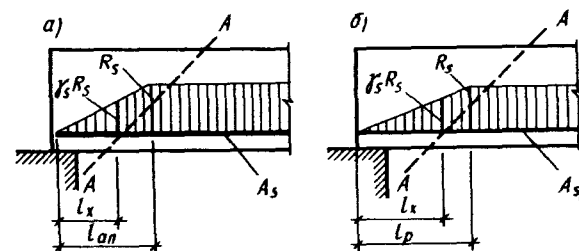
К определению расчетного сопротивления арматуры в расчетных сечениях, пересекающих продольную рабочую арматуру в пределах зоны анкеровки
